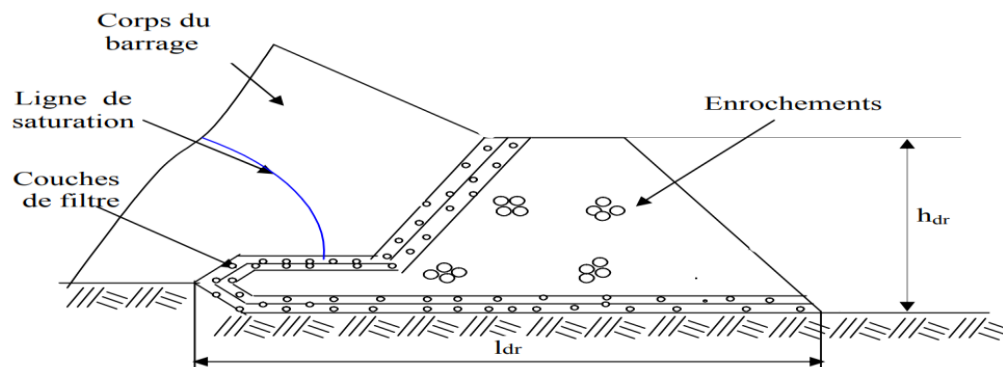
Prisme de drainage avec drain tapis interne sur fondations perméables
